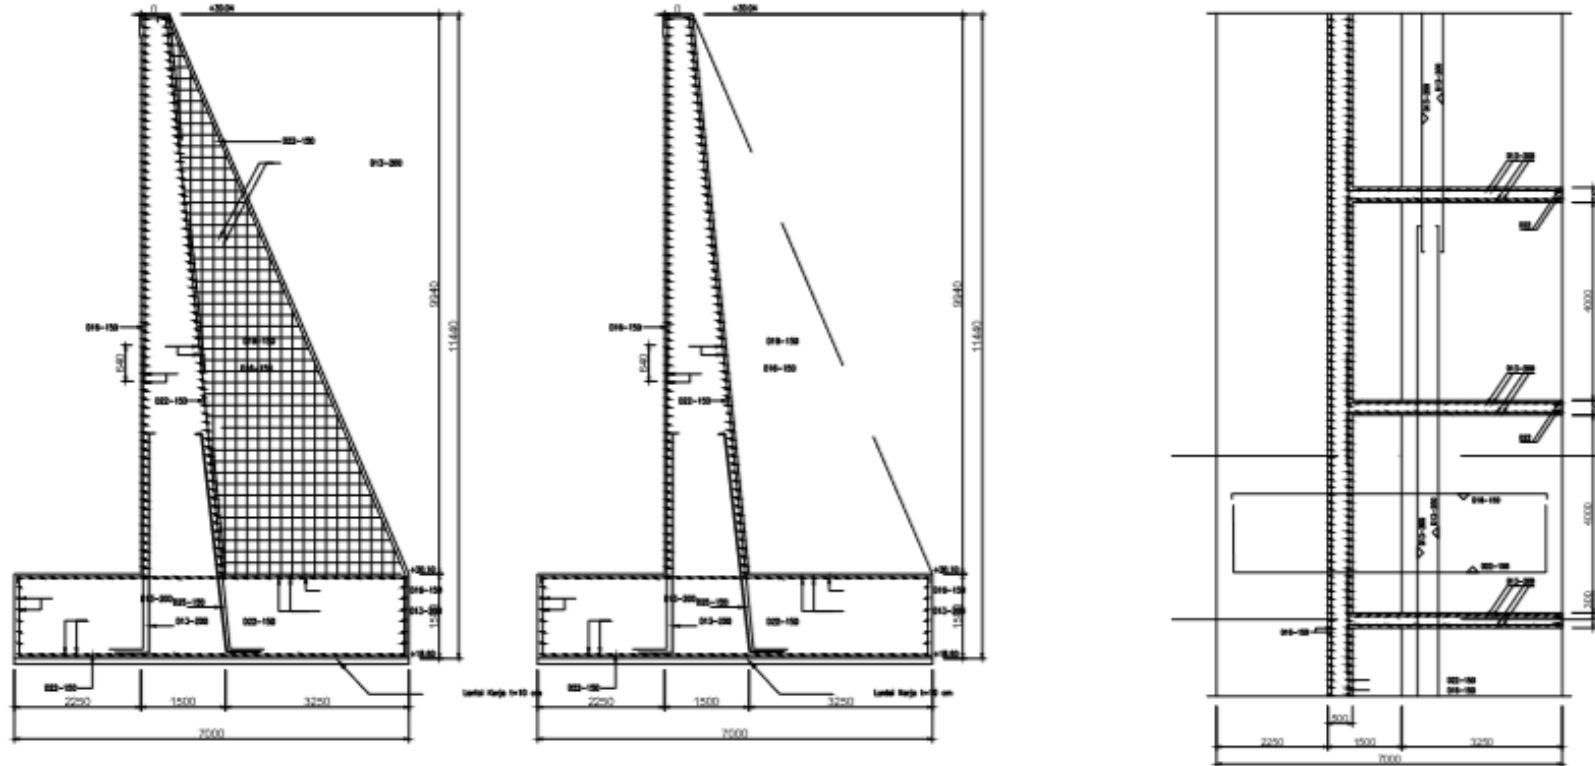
Potongan Detail dan Denah Tampak Atas Penulangan Dinding Penahan Tanah Tipe A
